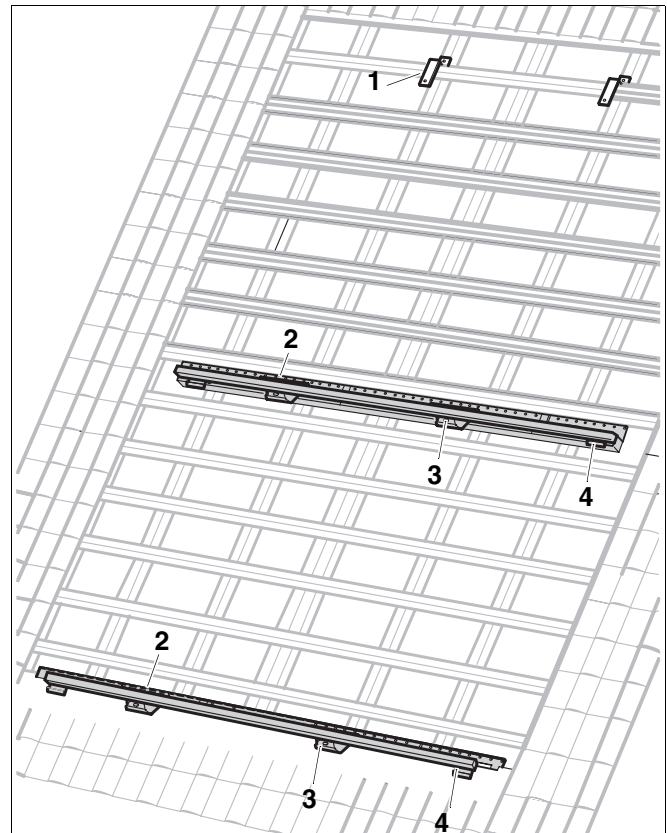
Befestigungssystem für zweireihige Kollektorfelder
